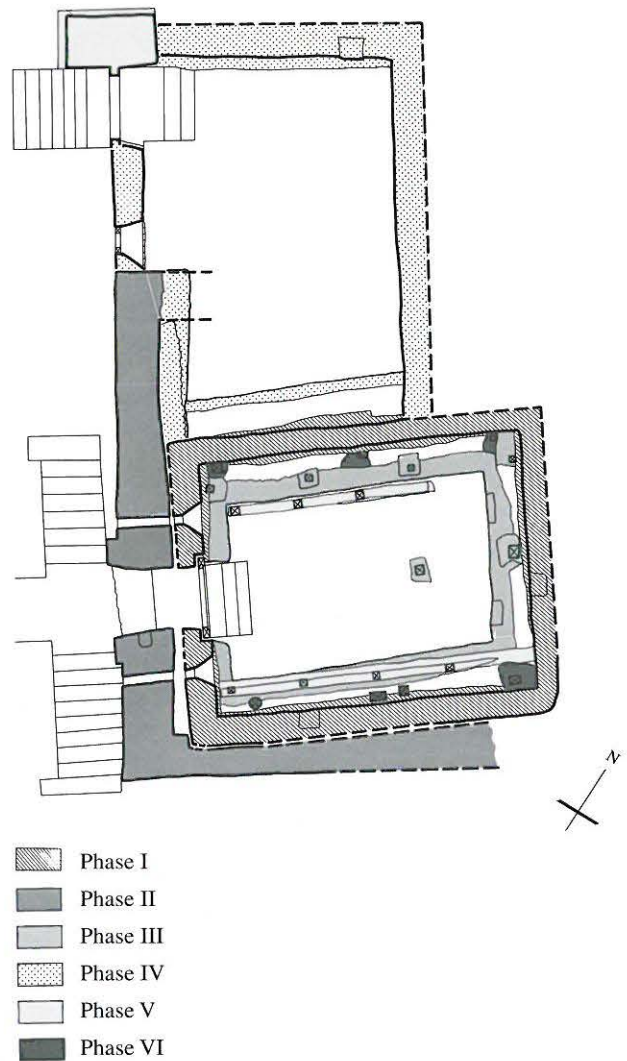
Hilterfingen, alte Thunstrasse 36. Kellergrundriss M. 1:150 mit Bauphasen.
